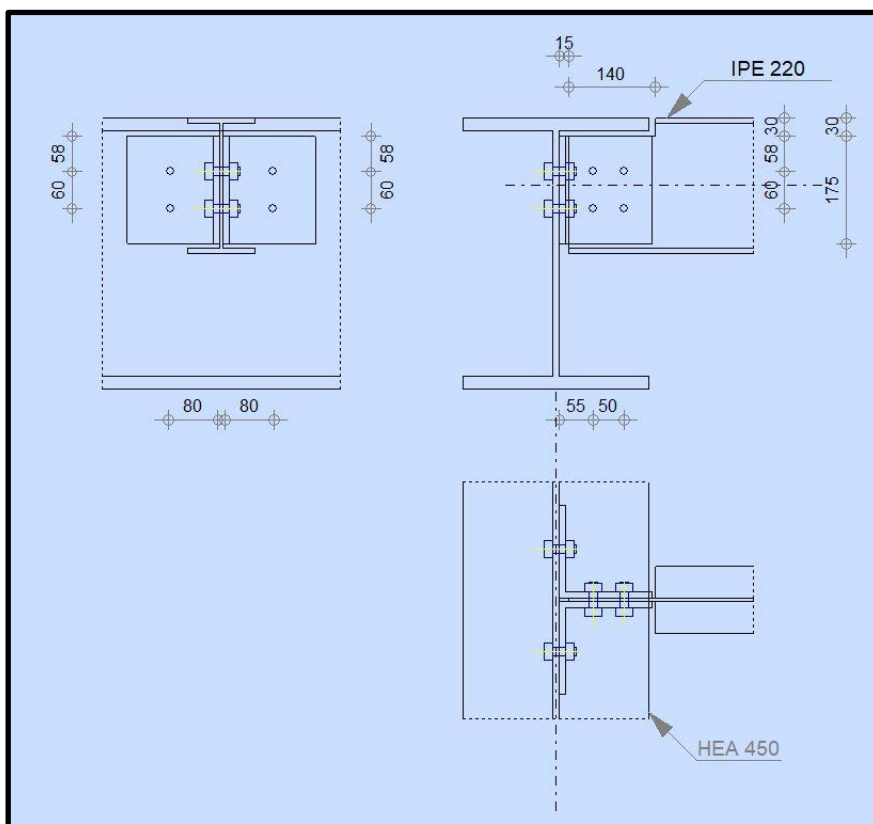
Schéma d'assemblage poutre HEA 450 – solive IPE 220
